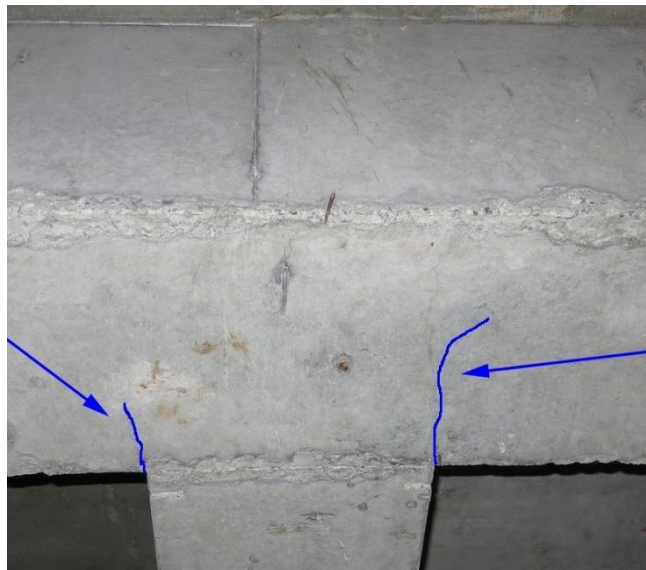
Formação das primeiras fissuras por falta de armadura de suspensão
